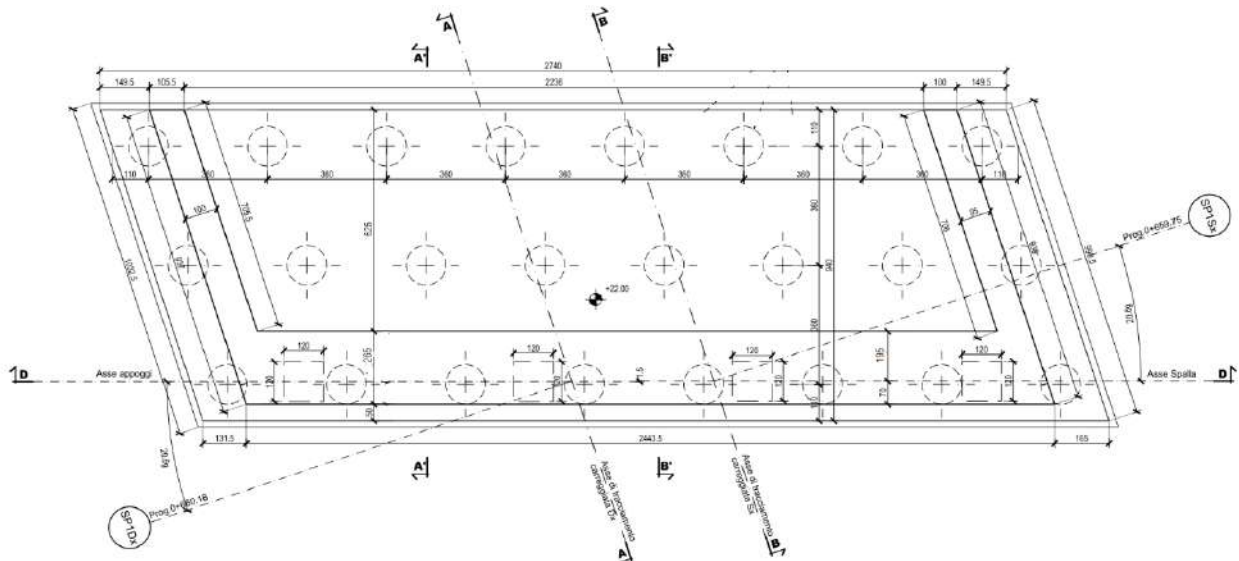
Vista planimetrica spalle SP1 ed SP2
